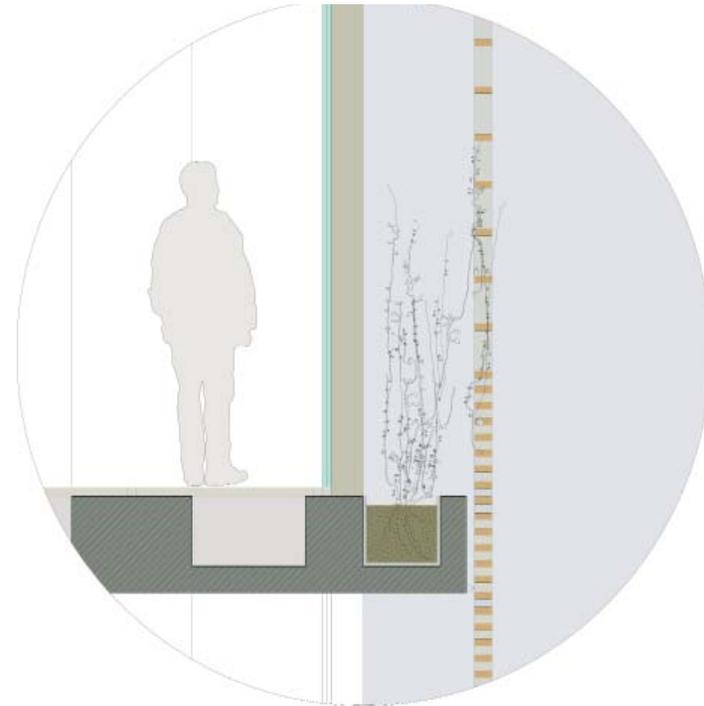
Detalle de jardinera perimetral proyectada (vista en Corte).
